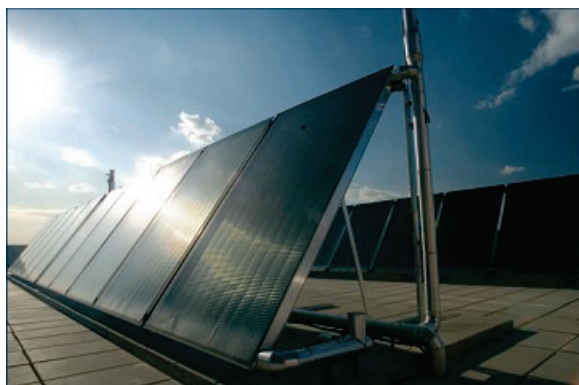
Ejemplo de montaje de un captador en cubierta plana (gasfriocalor.com)
